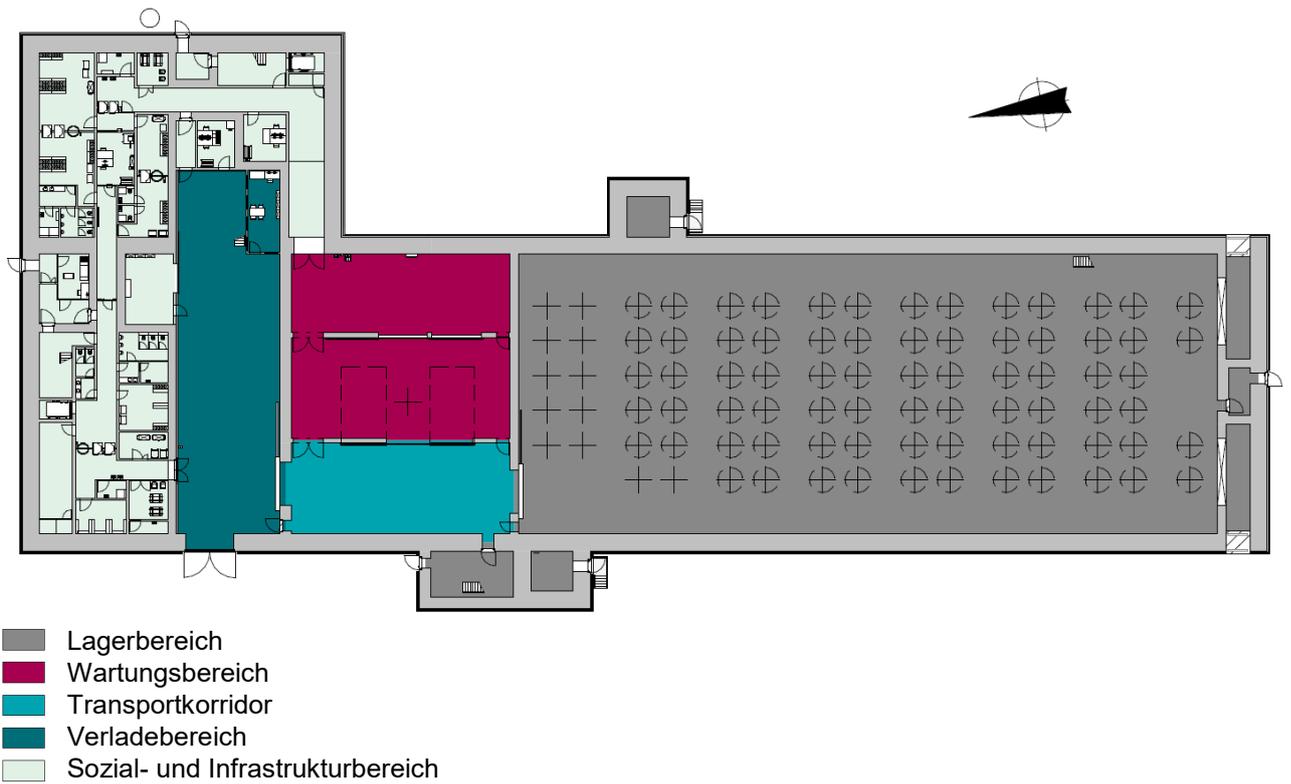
Grundriss für die 0,00 m-Ebene des Lagergebäudes
